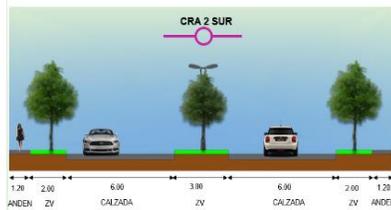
perfil vial av. 2 sur Fuente: archivo propio
